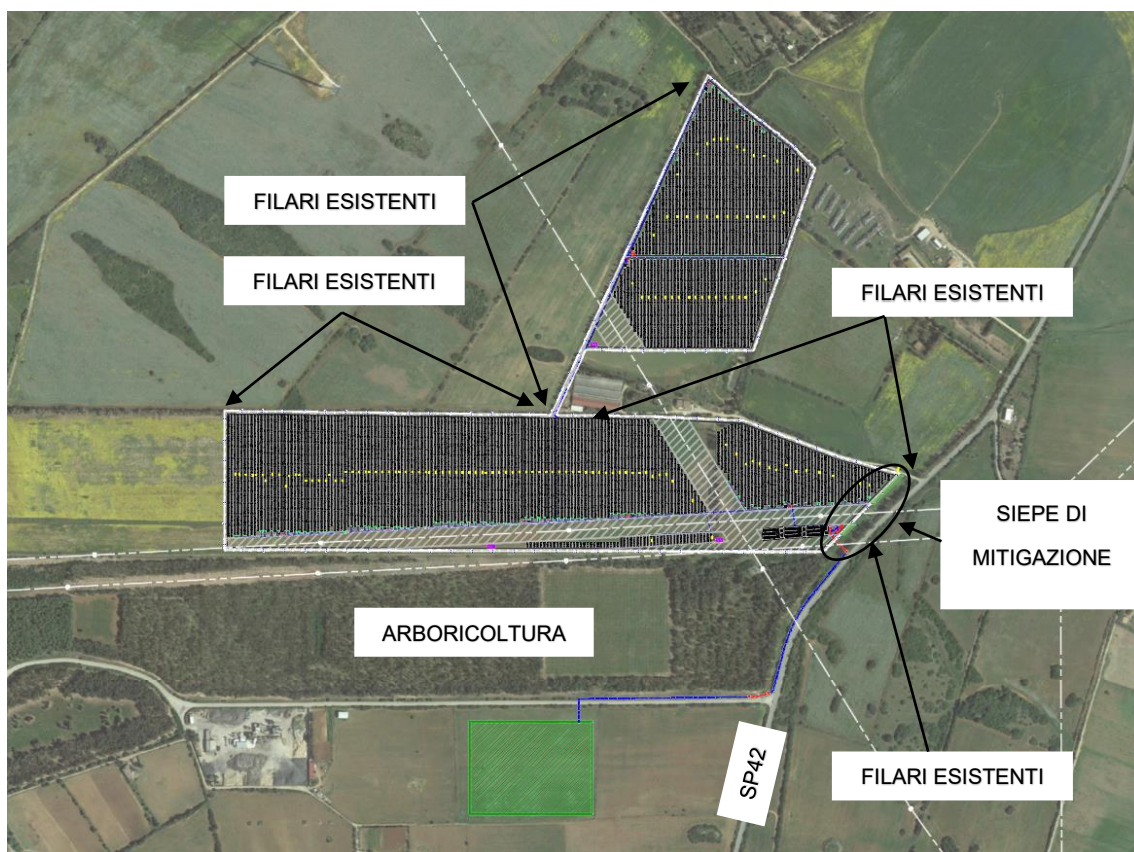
Planimetria con indicazione della vegetazione di mascheramento
